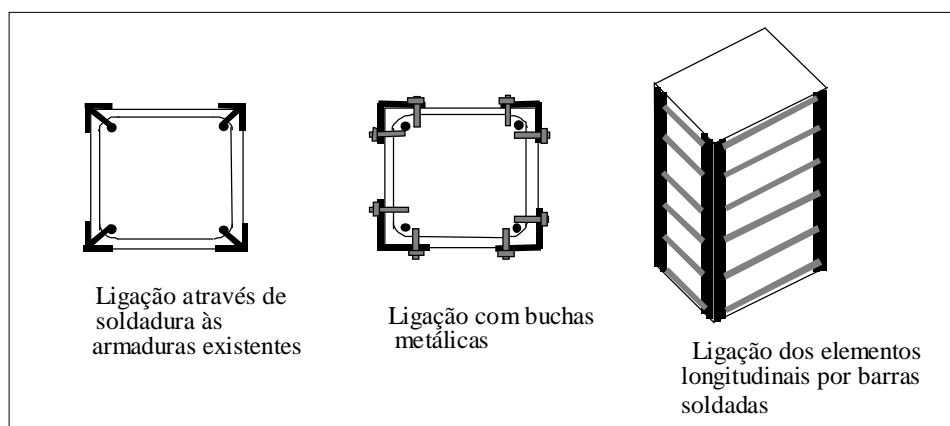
Reforço de pilares com introdução de elementos metálicos [31].
